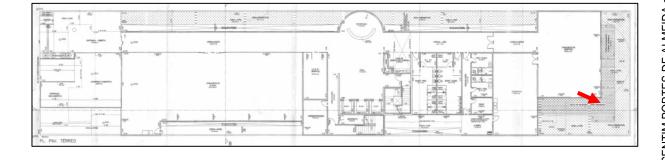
Hall de elevadores do pavimento térreo.
